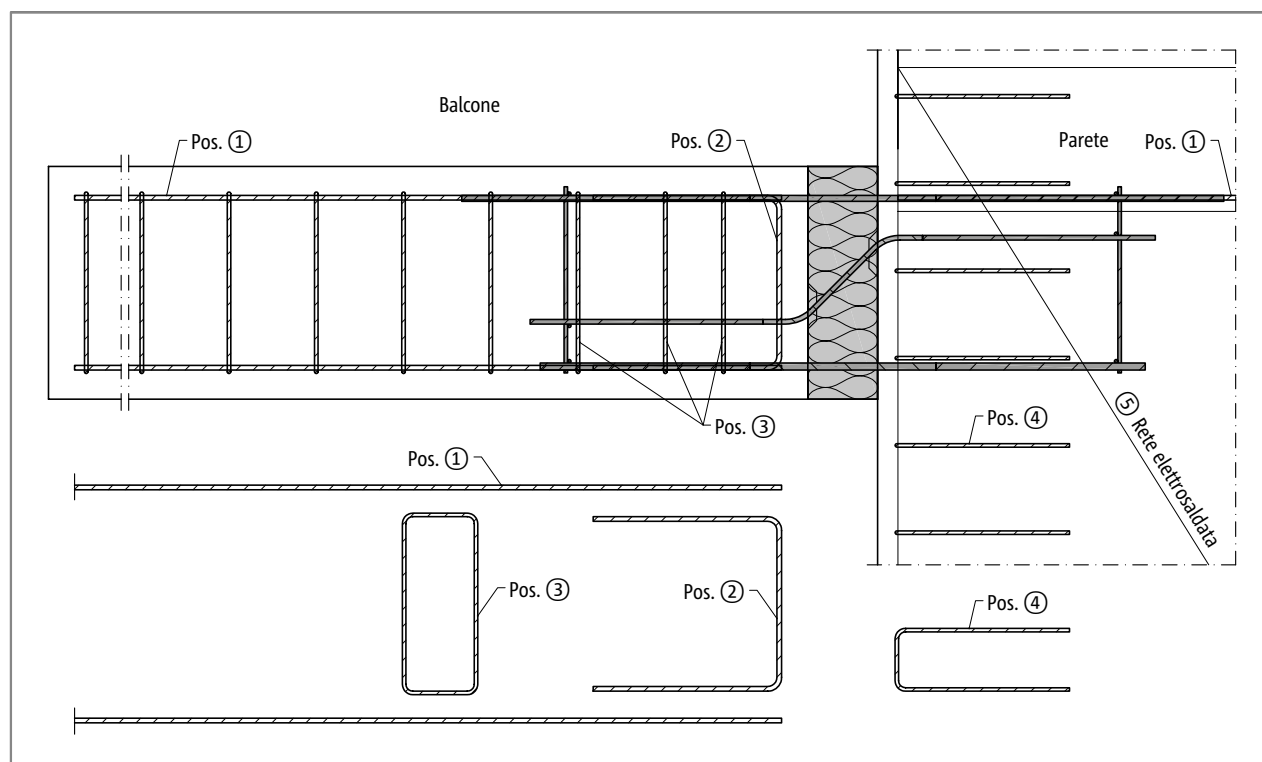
Schöck Isokorb® tipo SXT: armatura in opera
